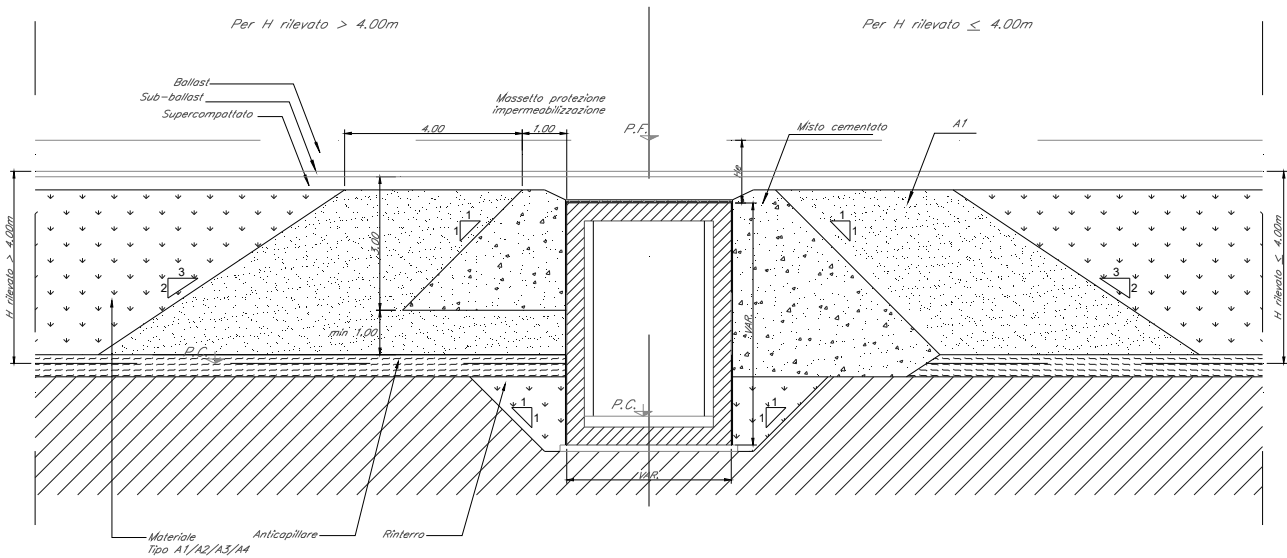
Zona di transizione rilevato-scatolare con  $1,35 < H_e \leq 1,55$  m
